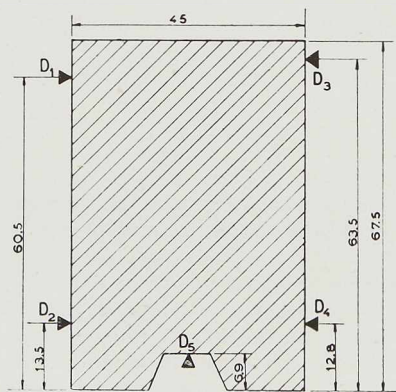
Mesure des déformations dans la section transversale médiane de la poutre, réalisée au moyen de 4 déformètres Huggenberger (D1 à D4) et d'un tensomètre Huggenberger (D5).
